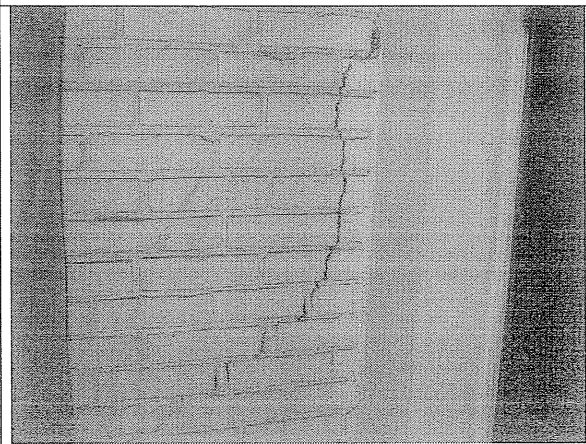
Agrietamiento en muro perimetral del patio posterior.
